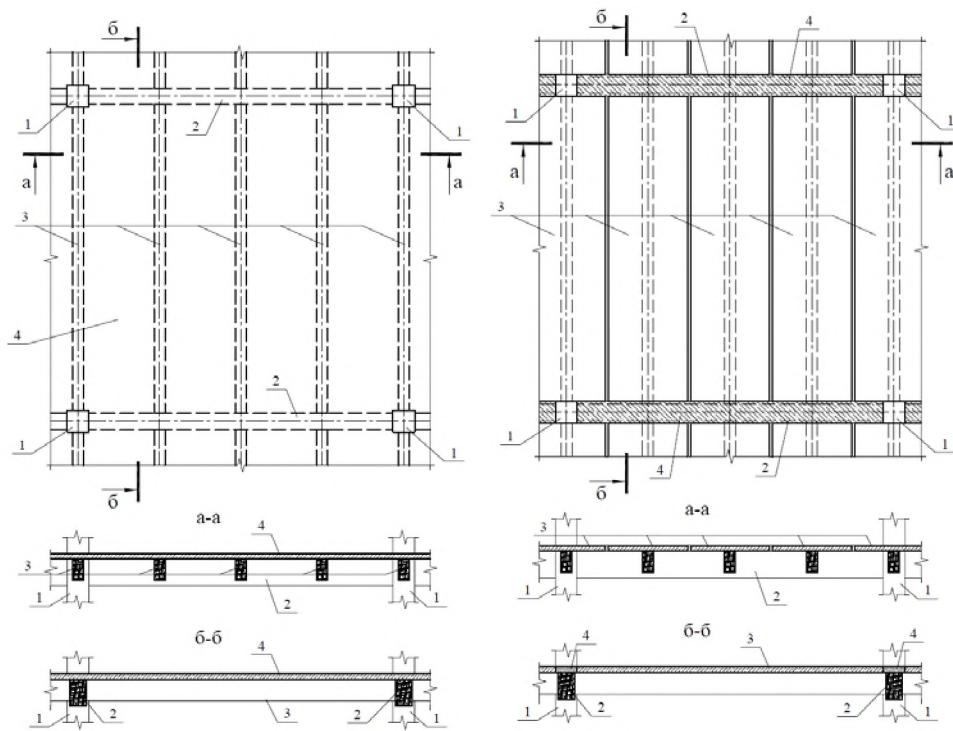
Схема збірно-монолітного (а) та збірного (б) гібридного деревозалізобетонного перекриття: 1 - колони; 2 - головні балки; 3 - другорядні балки; 4 - монолітна залізобетонна (грунтобетонна) плита / монолітна ділянка.
